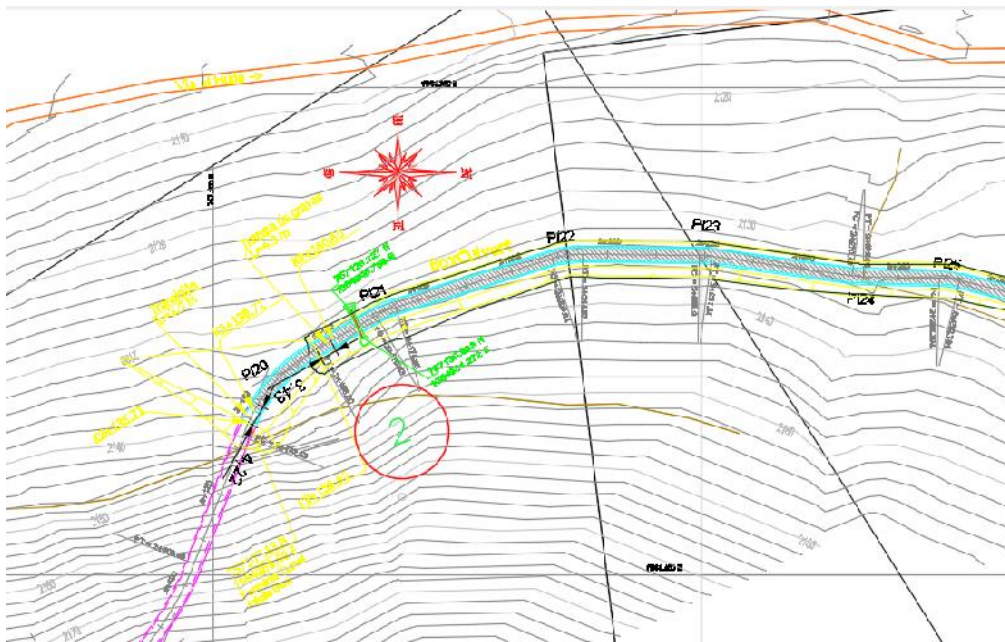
Ubicación cambio de trazado de Box Culvert. (PUNTO 1 Imagen 4).
